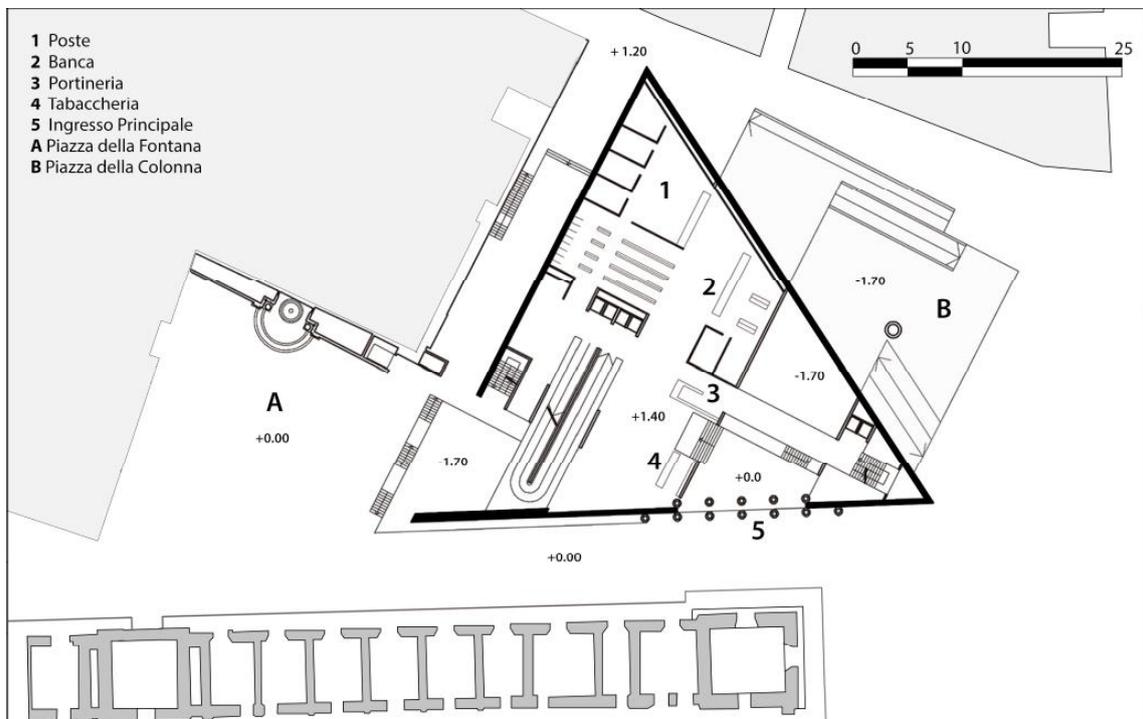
Pianta del piano rialzato. Progetto del gruppo Passarelli. Rielaborazione grafica Pia Marziano.
